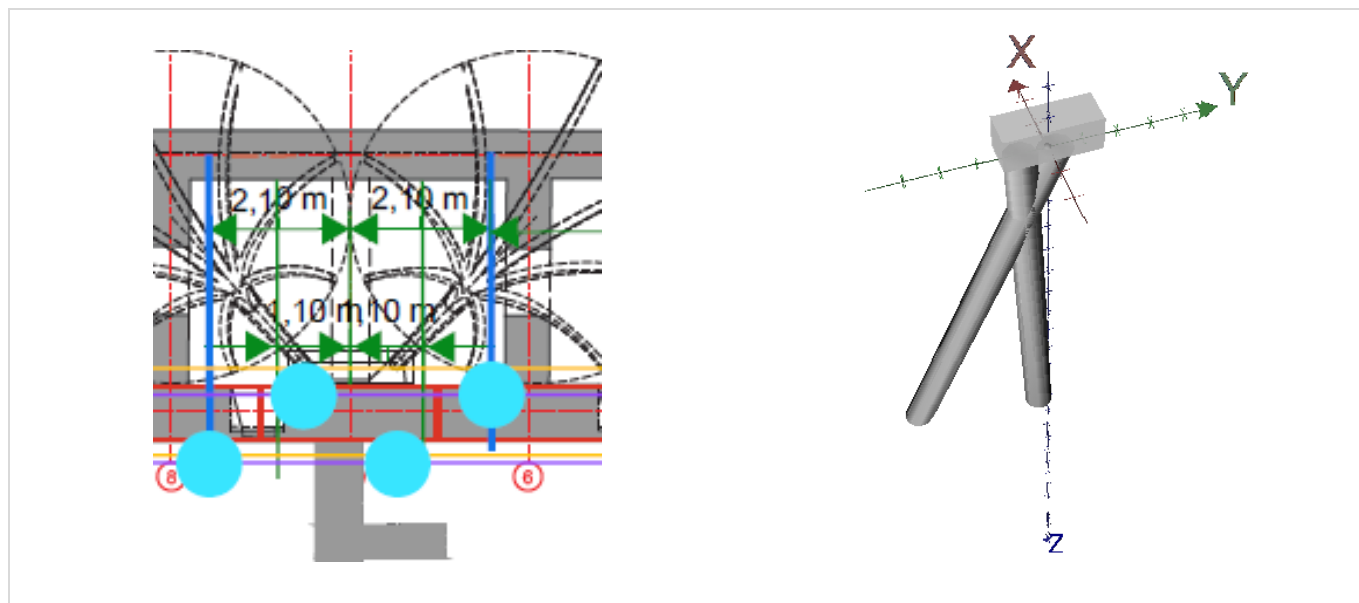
Calepinage des colonnes de jet grouting et modèle linéarisé de la fondation de la façade contemporaine au droit des zones d'influence des poteaux inclinés 1001 à 1006
